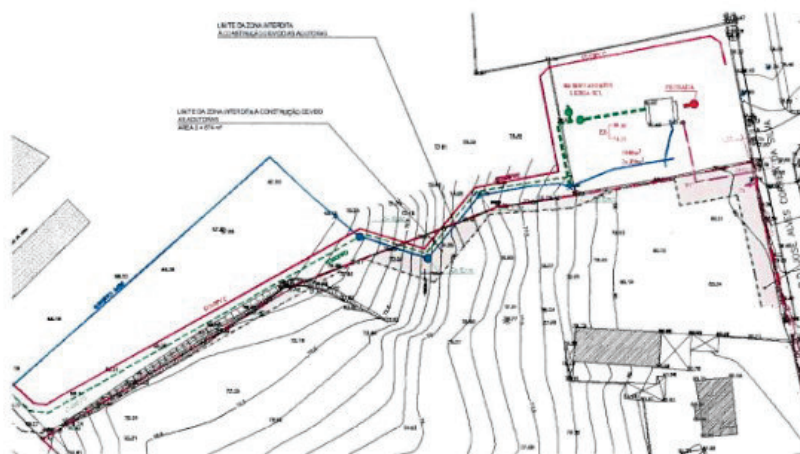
Figura I – Implantação das condutas na área do loteamento, com identificação da faixa de proteção.
